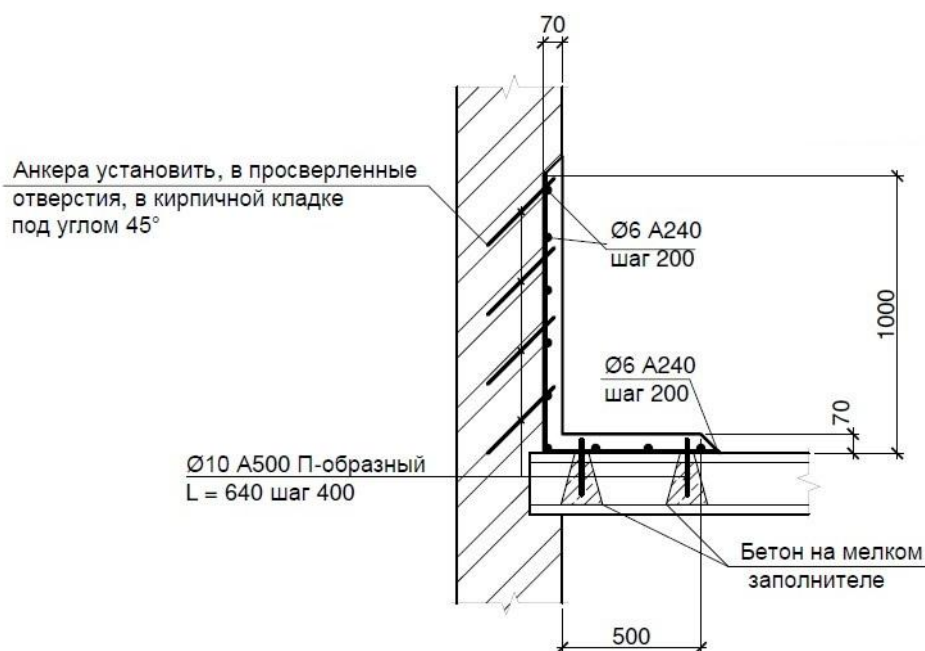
Антисейсмические пояса без вскрытия наружных стен
